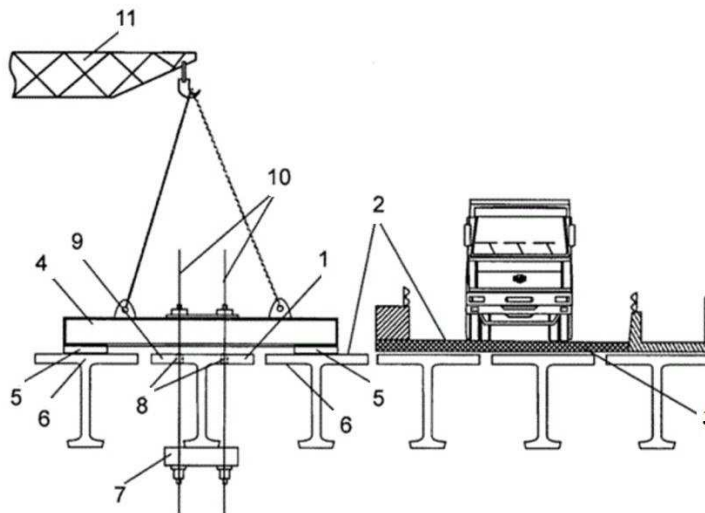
Спосіб демонтажу аварійної балки прогонової будови моста: 1 – аварійна балка; 2 – прогонова будова; 3 – тимчасове покриття; 4 – траверса; 5 – підкладки; 6 – сусідні балки; 7 – під траверса; 8 - стропувальні отвори; 9 – аварійна балка; 10 – тяги; 11 – підйомними кран [2]
